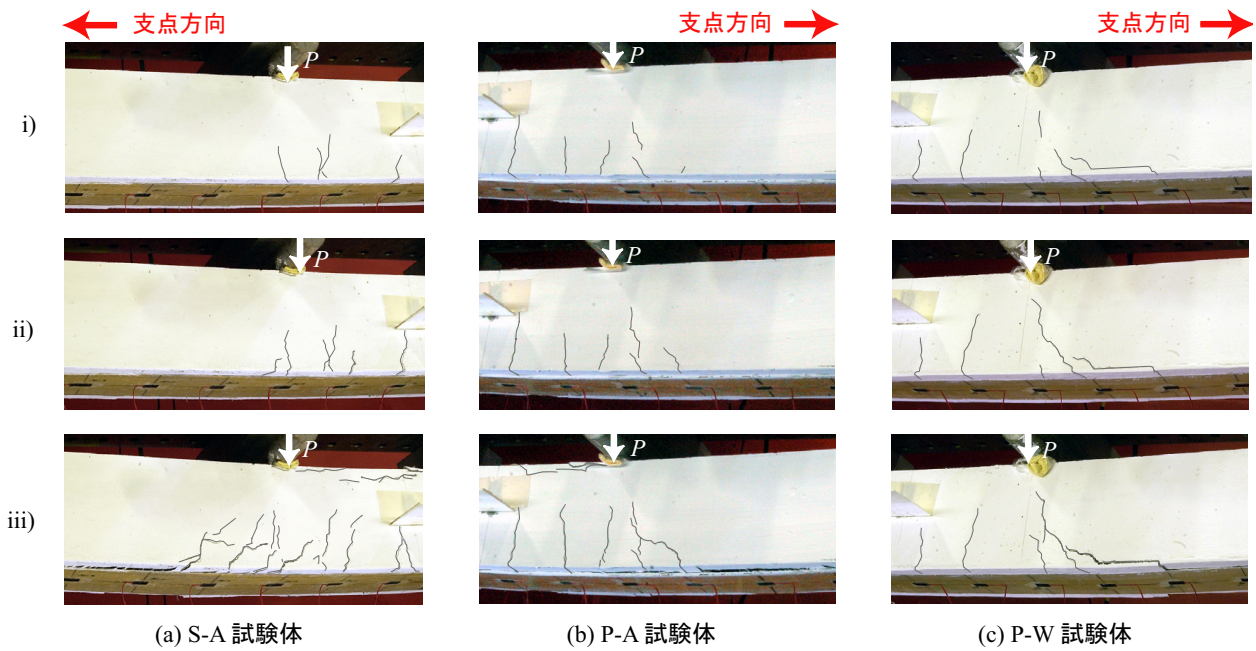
梁側面のひび割れおよび下面における補強材の剥離性状
